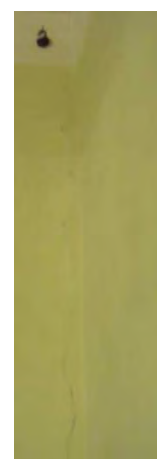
Cap. 6: Grieta al lado de la unión de los muros
